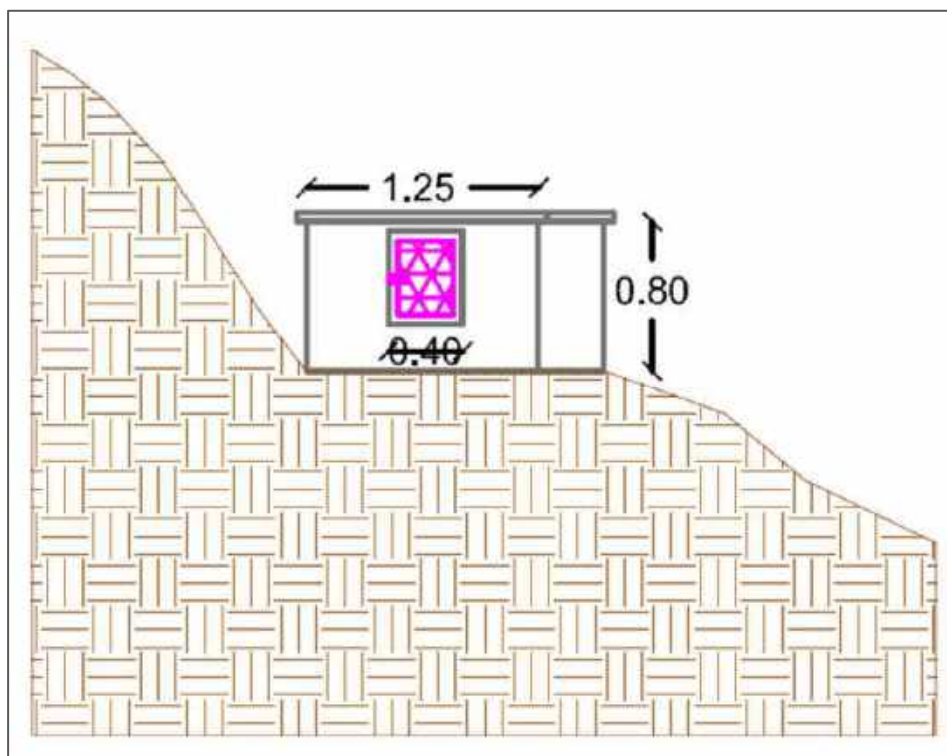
Prospetto frontale Sorgente 2 Le Pierine
